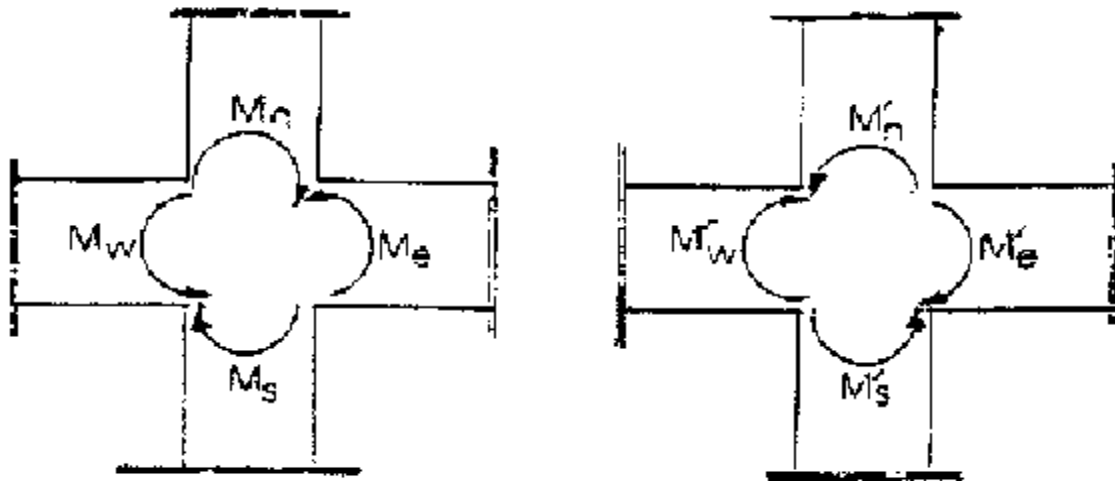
dimensionnement d'un nœud poutre-poteau
